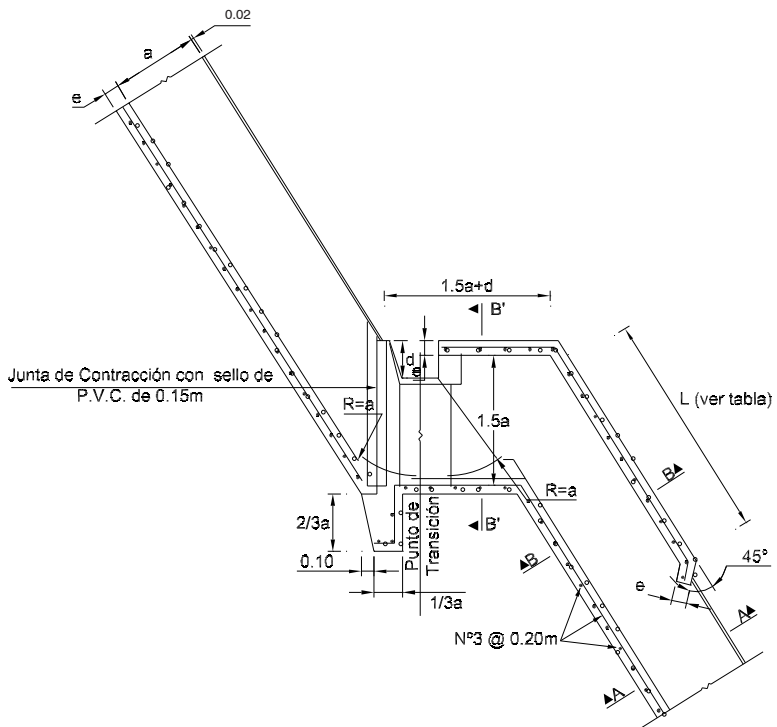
Vista en planta de un canal en rápida con tapa y columpio
